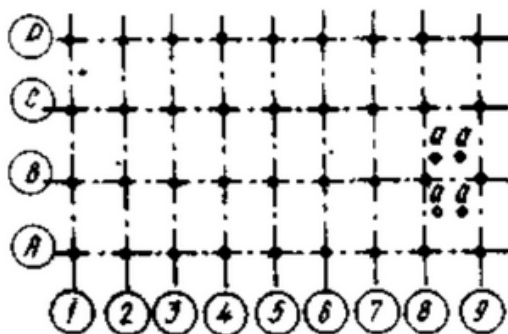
Сетка фундаментов одноэтажного промышленного здания
